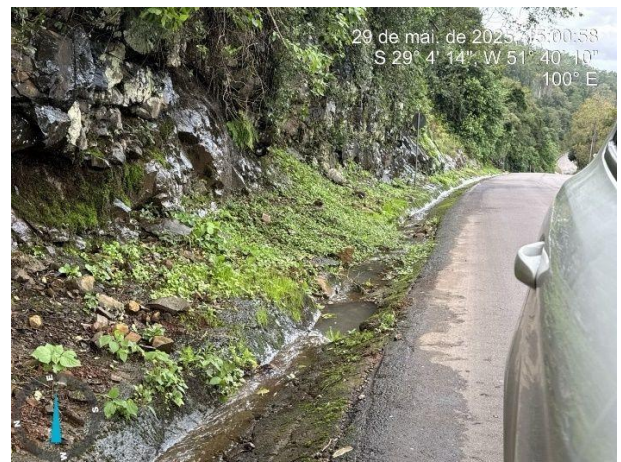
Talude instável e danos em elementos de drenagem em vistoria de maio/2025
